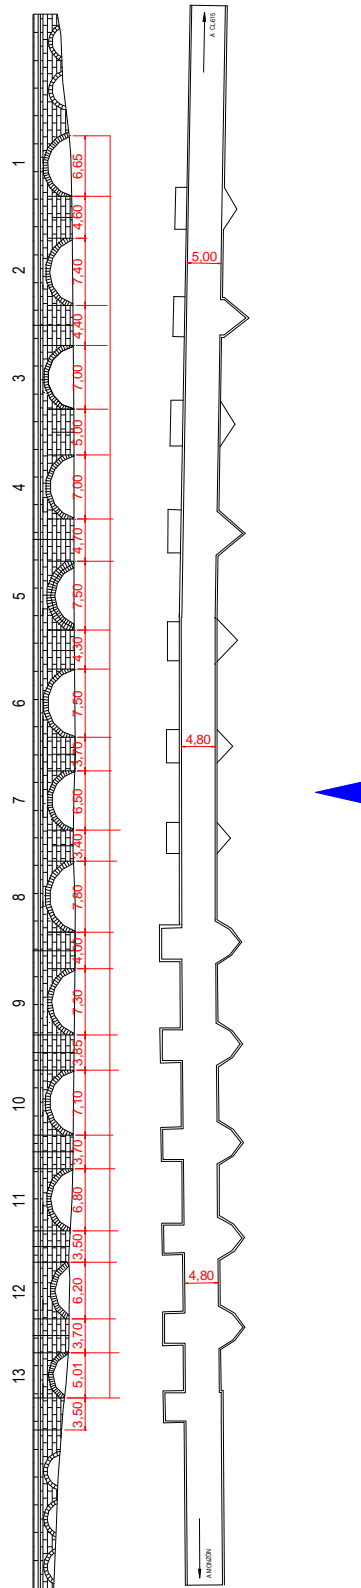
Planta y alzado de aguas arriba del puente en Monzón de Campos
